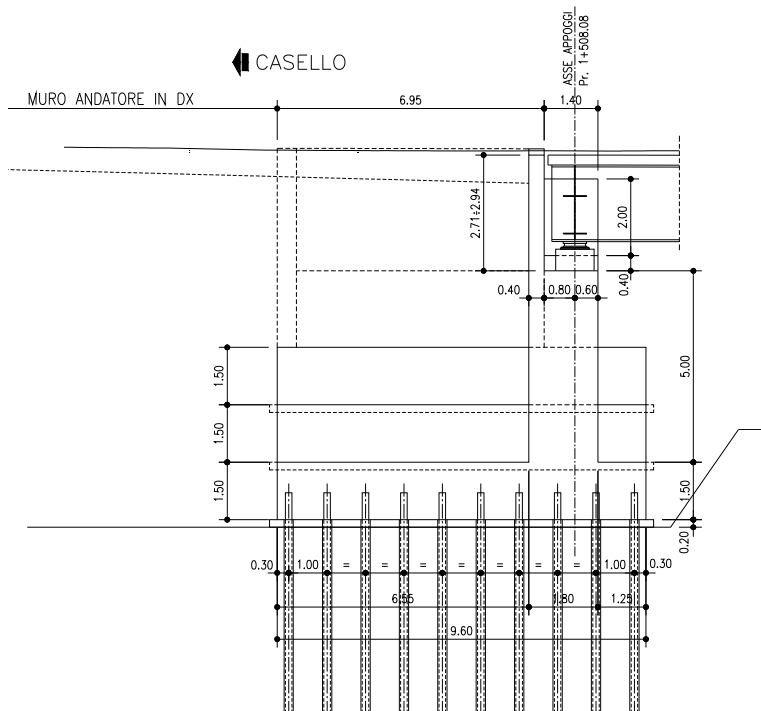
Spalla A – Sezione Trasversale Fondazioni
